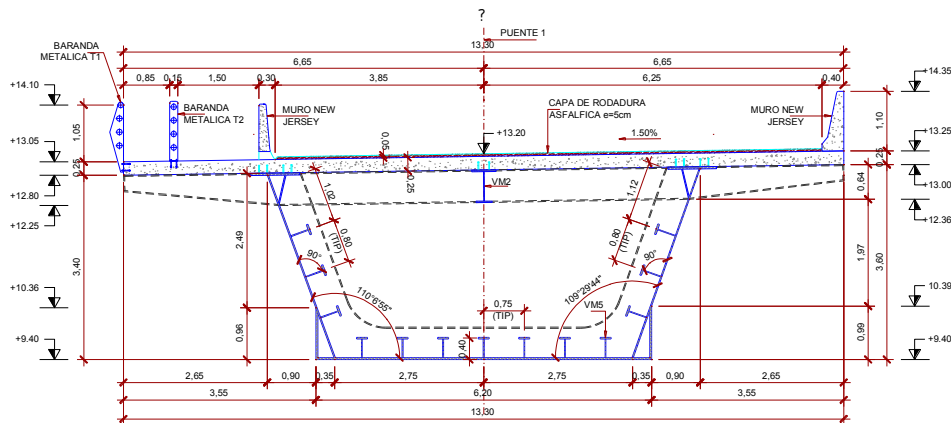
Corte transversal de la superestructura no rigidizada (Fuente: Elaboración Propia)
